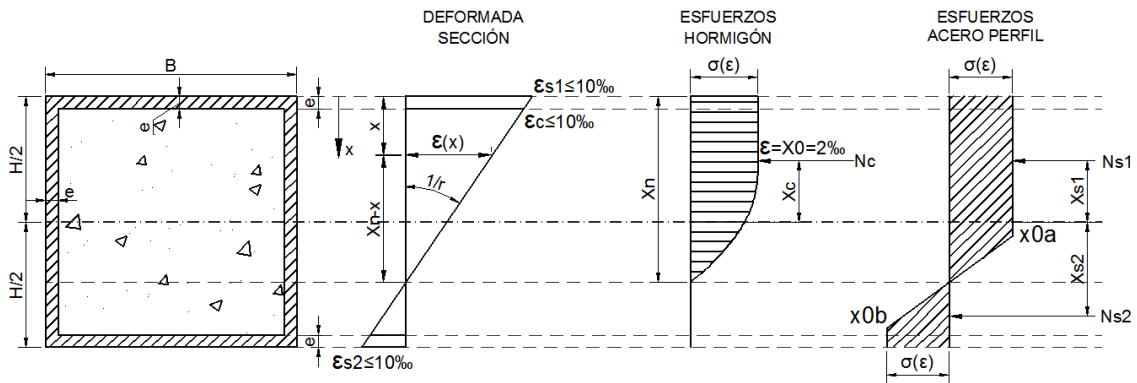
Diagrama esfuerzo deformación para sección de acero rellena de hormigón.
